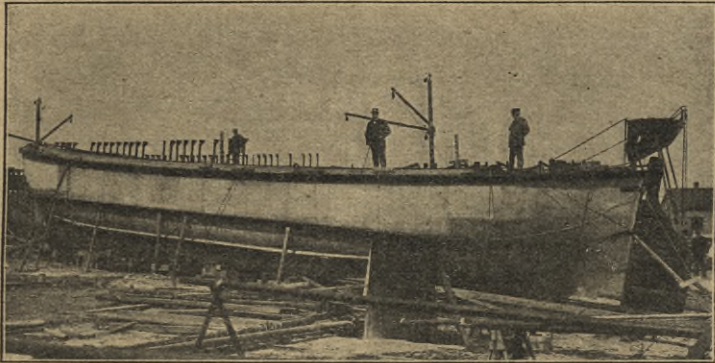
Eisenbeton-Prahm, Bauweise des Verfassers.
